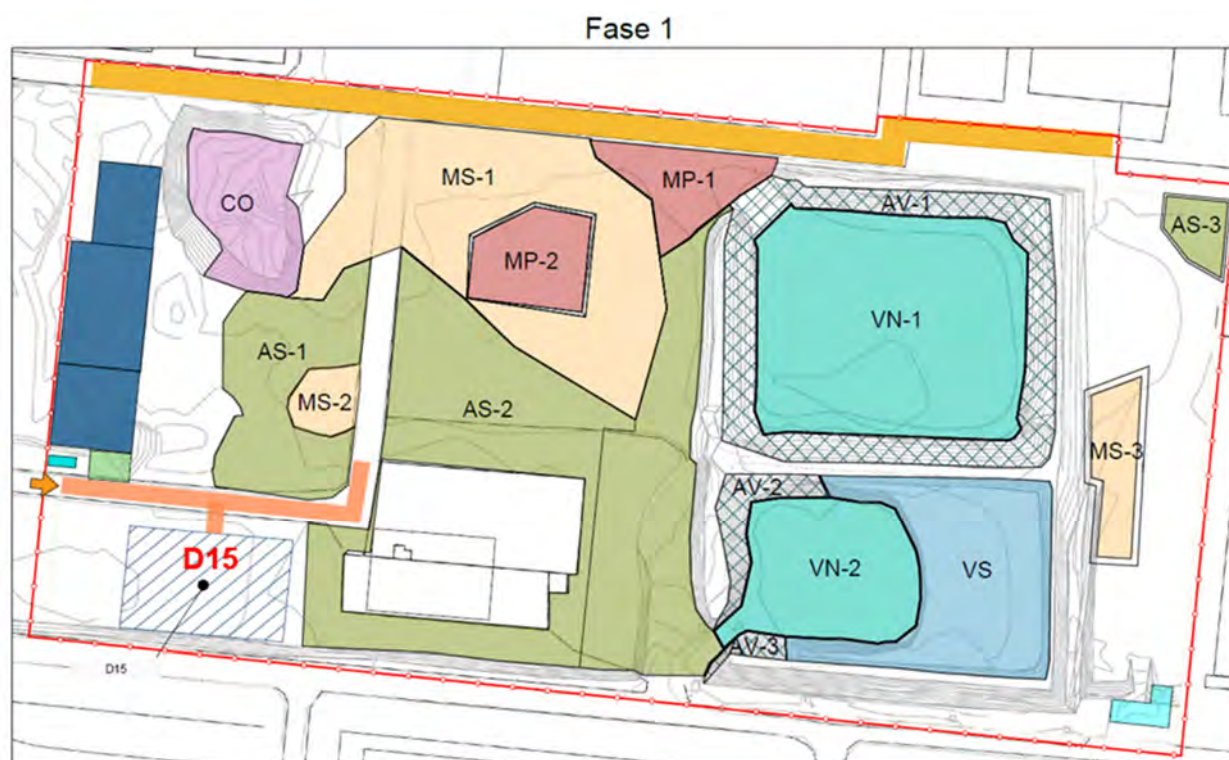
Planimetria area palte con individuazione delle zone di scavo e del deposito preliminare D15.
